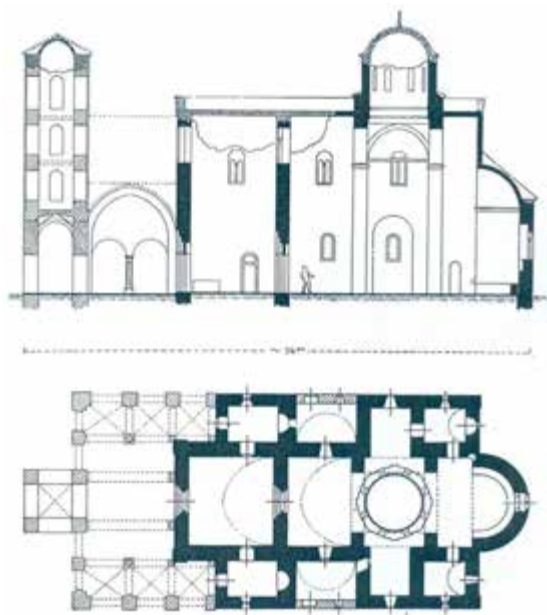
Chiesa della S. Trinità, pianta e sezione longitudinale, monastero Sopoćani (da Nenadović 1980)
